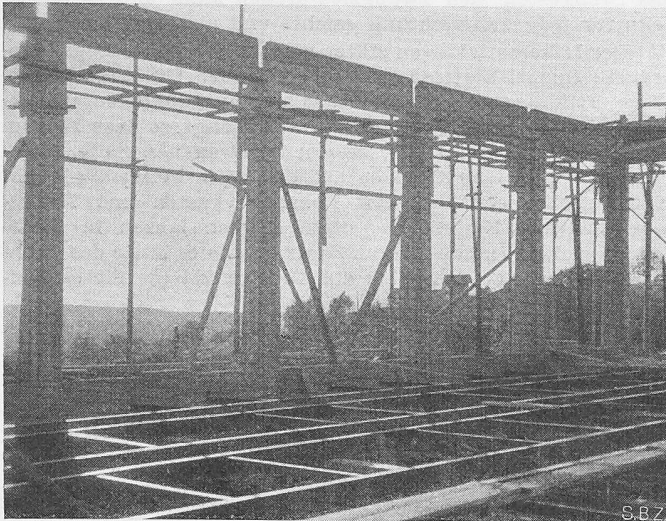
Eisenbetonkonstruktion mit Schlitzn für die Hetzerbinder
